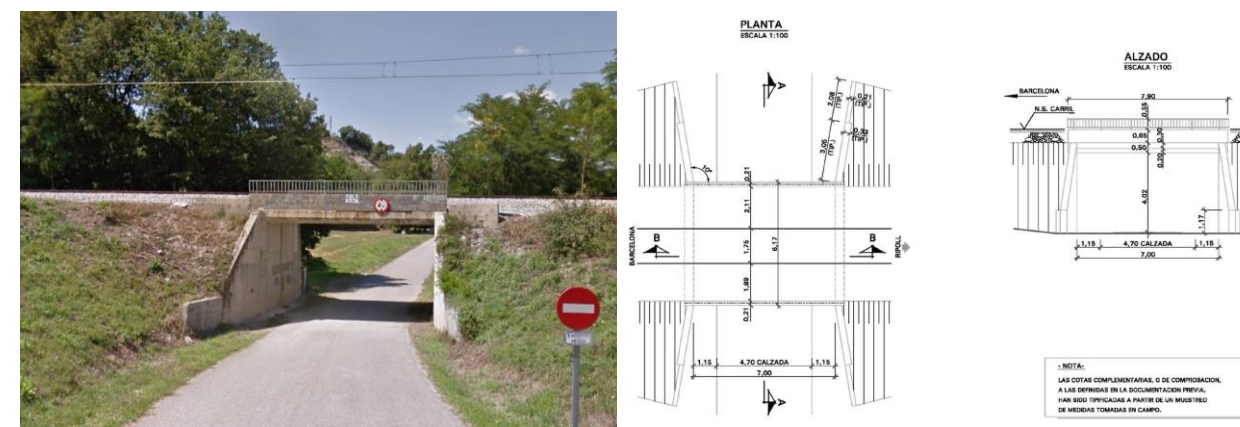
Paso inferior existente en carretera local en el P.K. 59+230. Para la duplicación se contempla el ensanche de la estructura.
